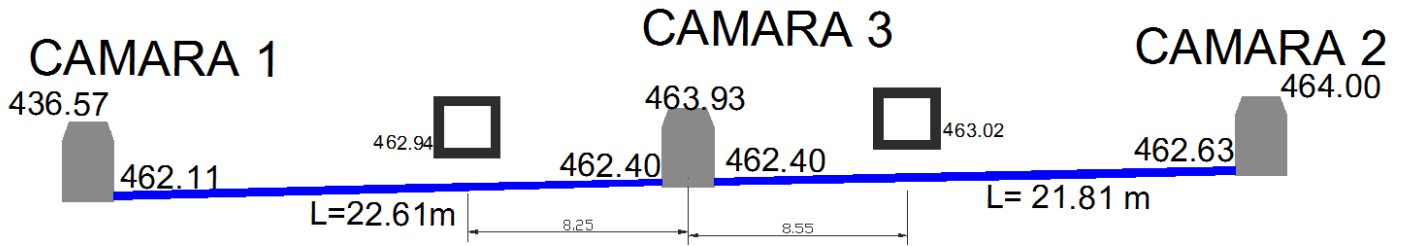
Perfil de Cámaras propuesto. Cloaca RD-L
